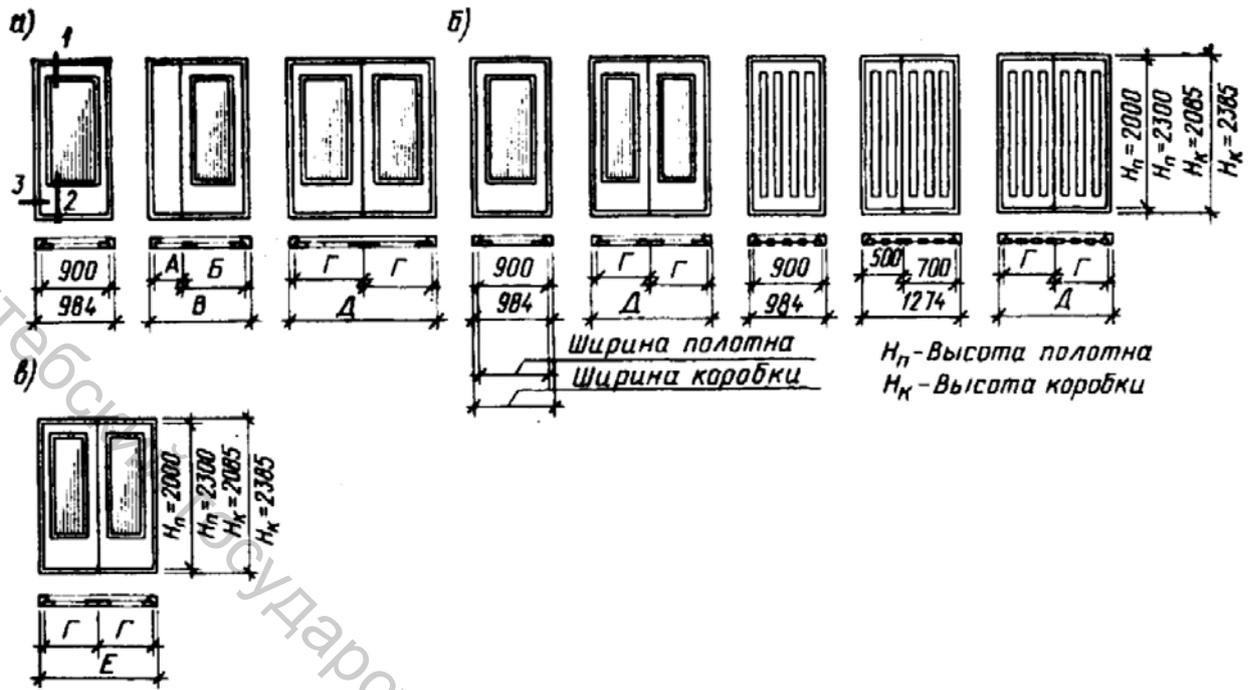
Двери деревянные наружные для жилых и общественных зданий:
